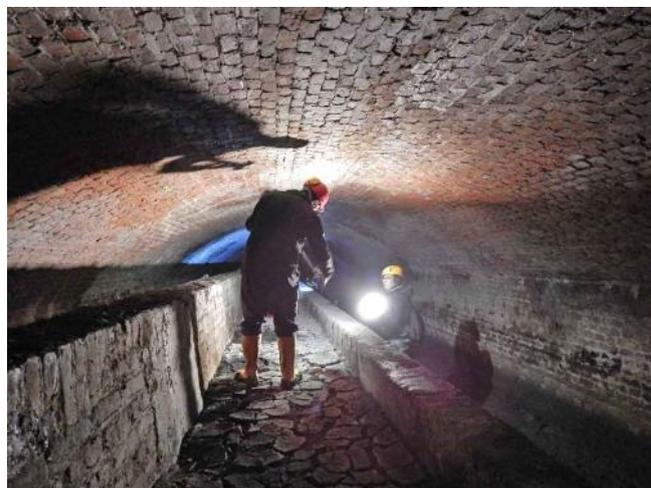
Canale sotto la Ferrovia Ferdinandea: internamente è strutturato su tre livelli.
